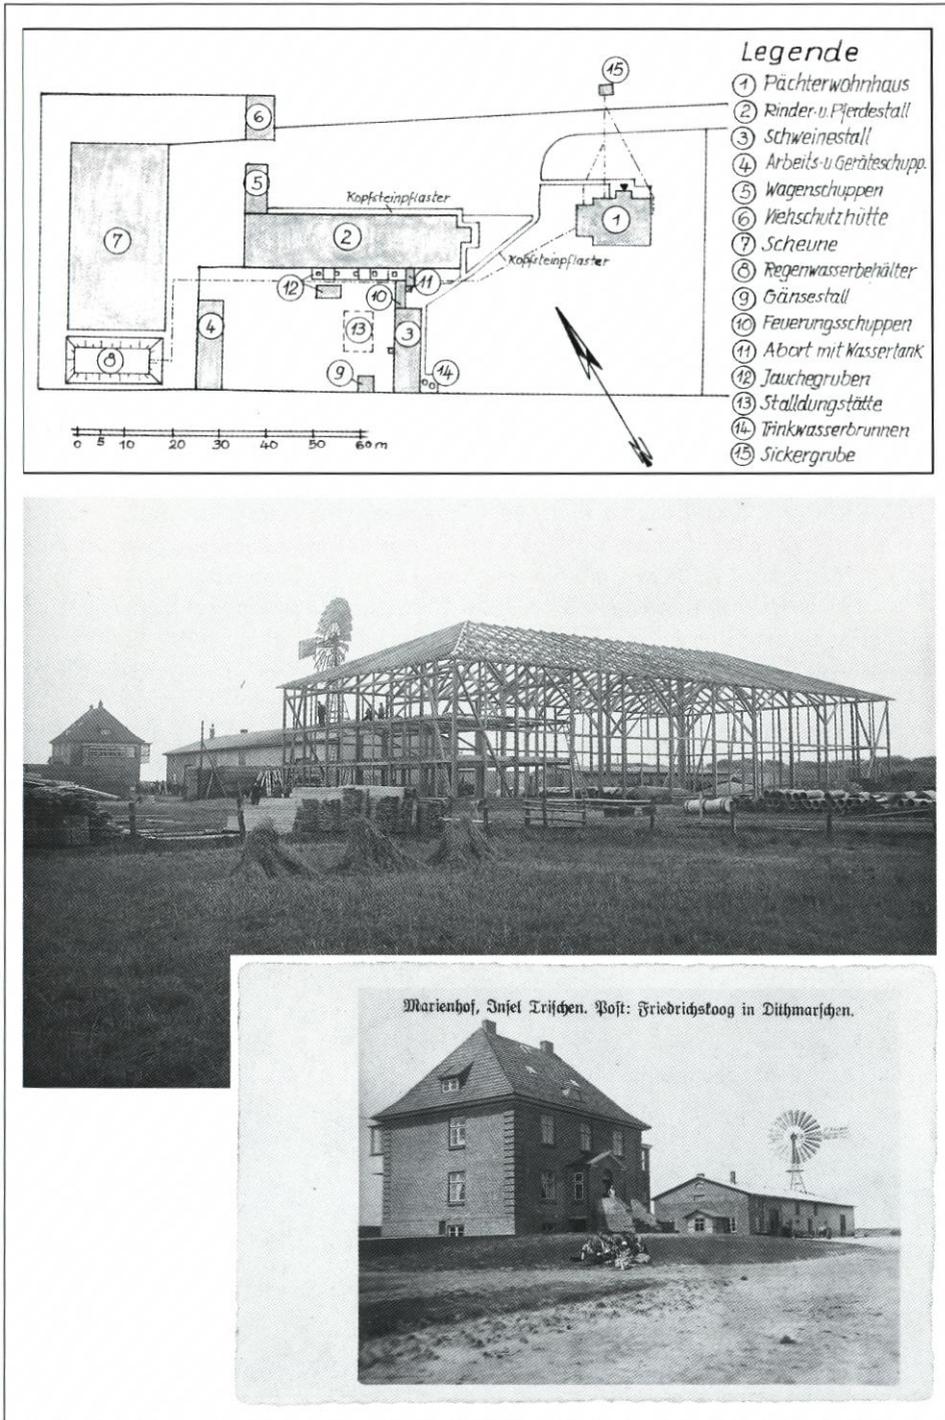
Lageplan der Gebäude des Luisenhofes sowie Fotos des 1924 errichteten Wohnhauses und Stalles, und der 1928 im Bau befindlichen Scheune
